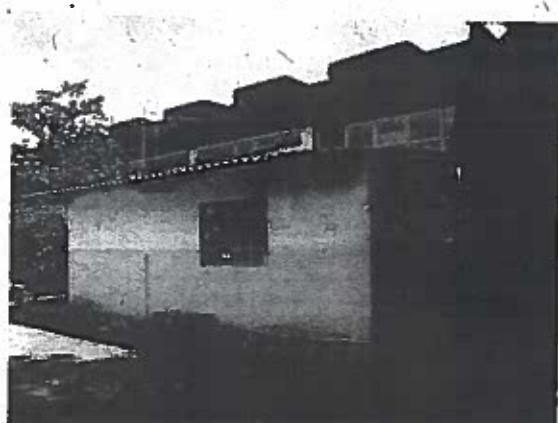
Vista Frontal/Lat. Dir. da seg. edificação
